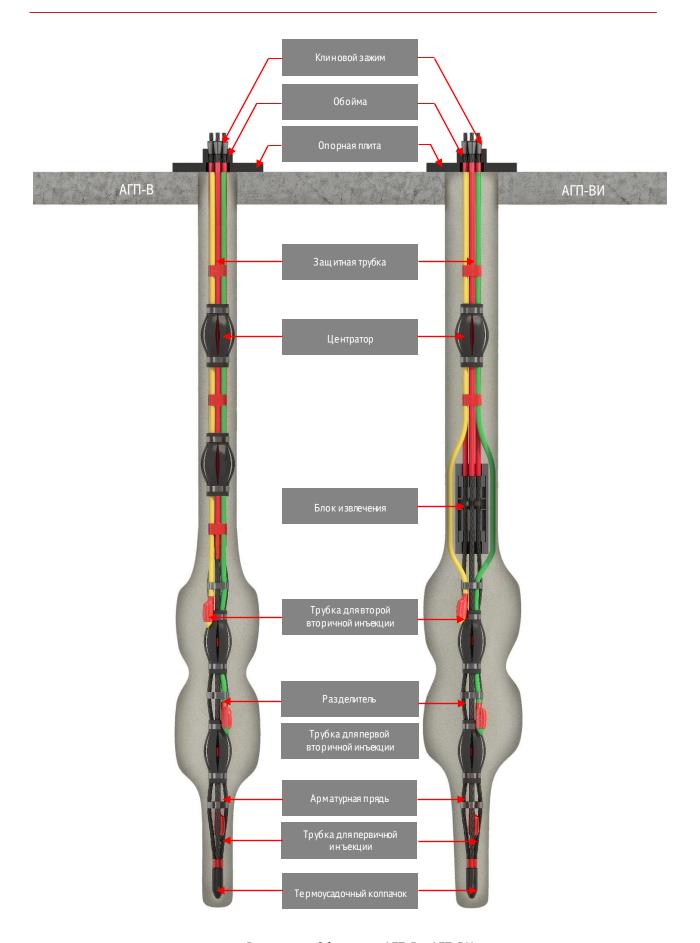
Общий вид АГП-В и АГП-ВИ
